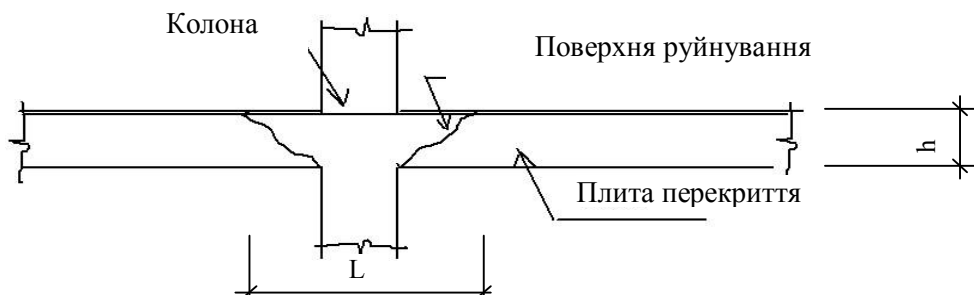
Схема для розрахунку монолітних плит перекриття на продавлювання
